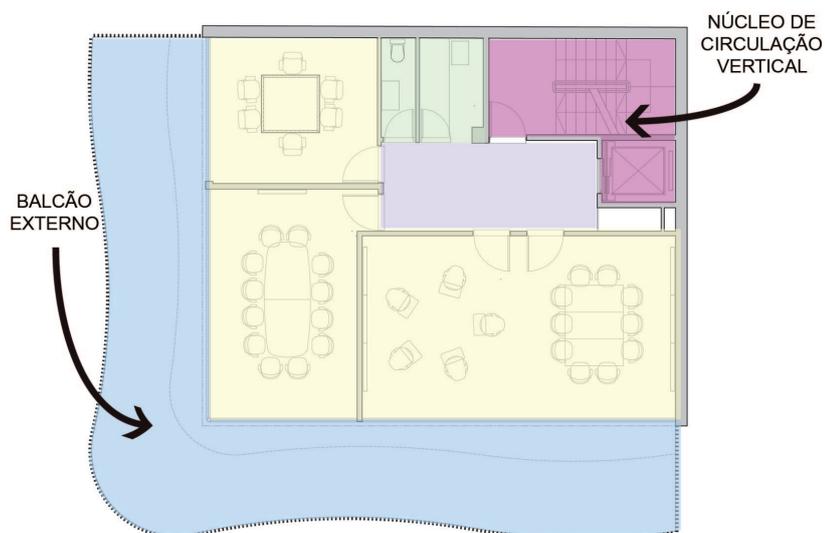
Oitavo pavimento – salas de reuniões e auditório flexível
